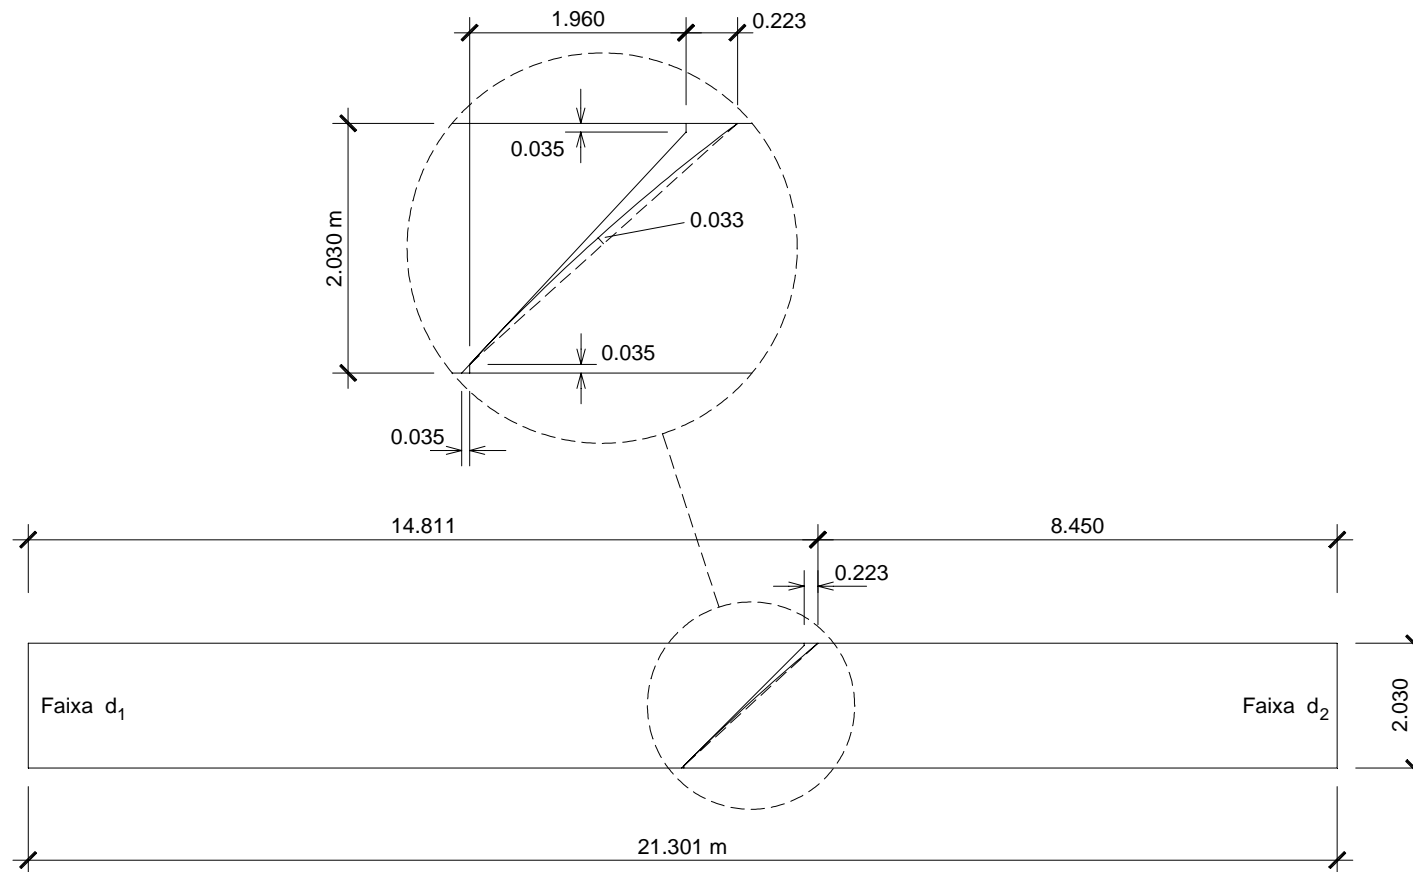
Detalhamento do corte das faixas  $b_1$  do painel 1 ("corpo").
